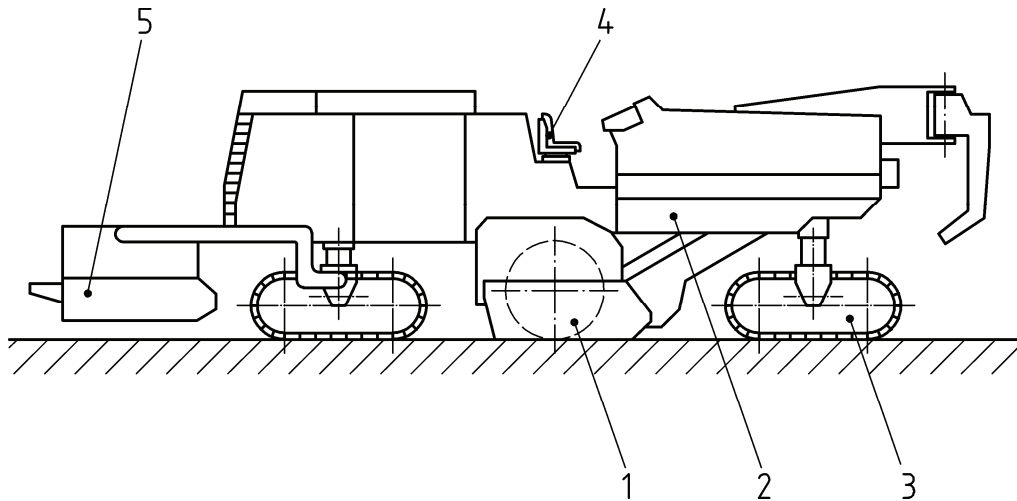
Bodenstabilisierungsmaschine mit mittigem horizontalem Rotor
